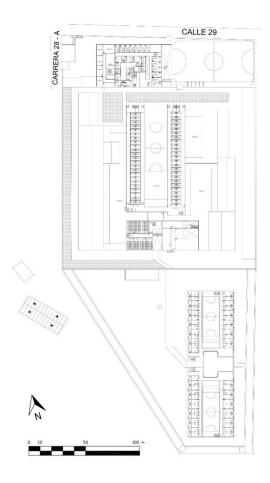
Plano Primer Piso EPMSC-RM Pasto. Fuente: Elaboración propia
